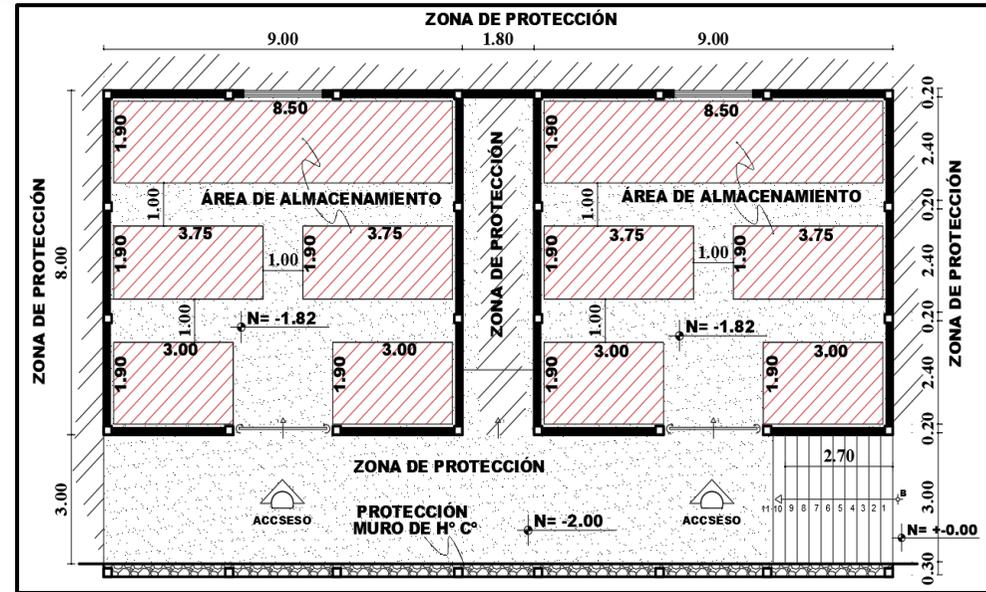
Planta arquitectónica bodega 2 de la importadora ACMIF
